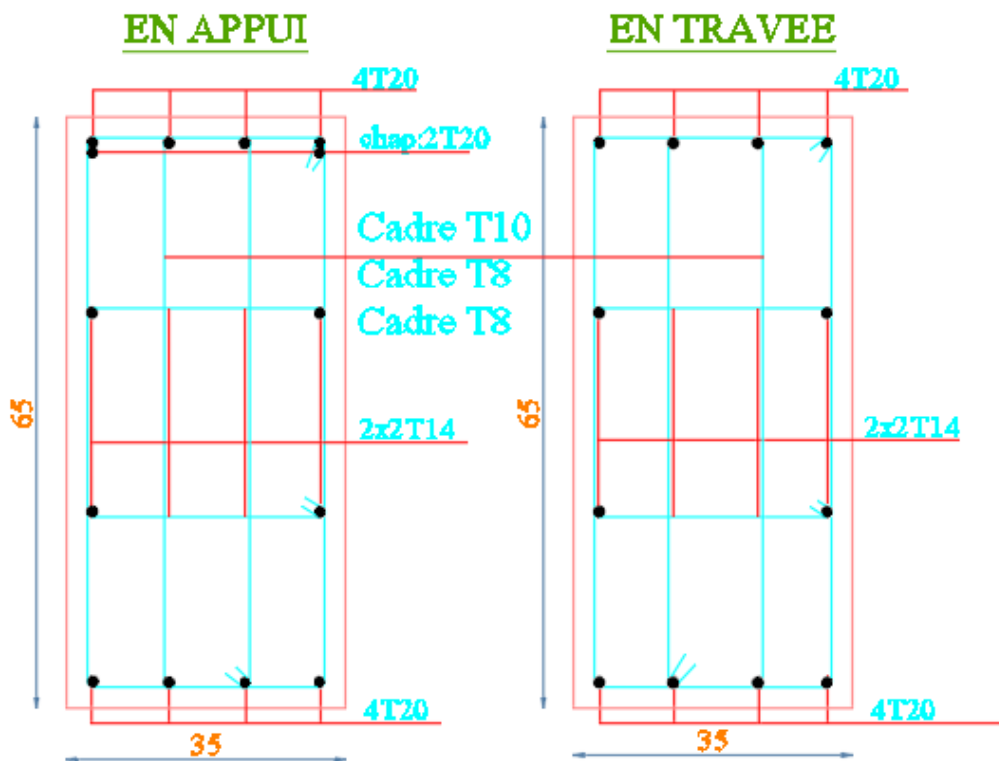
Schéma du ferrailage de la poutre principale 65*35
